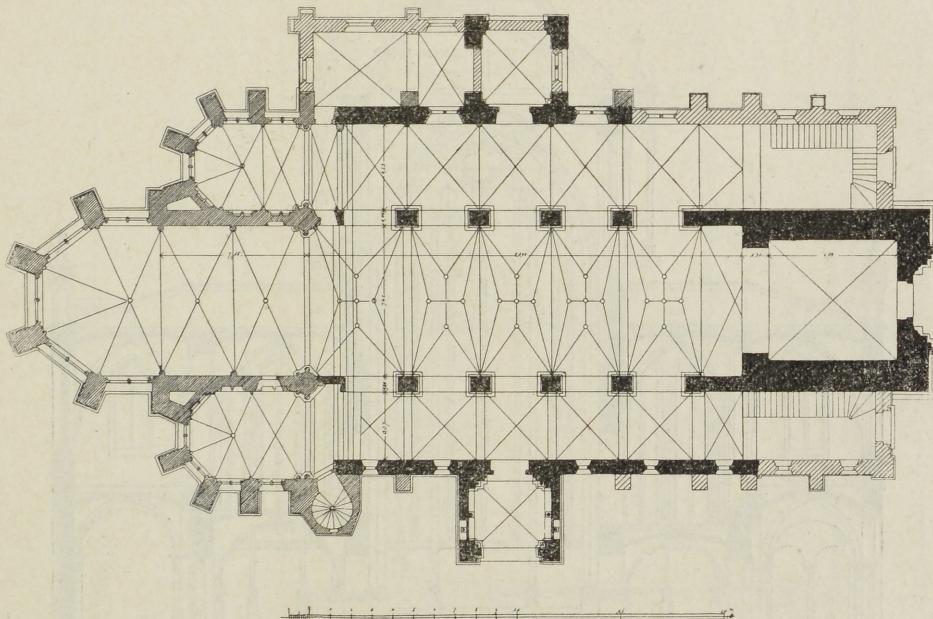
Siegburg. Grundriss der kathol. Pfarrkirche.
